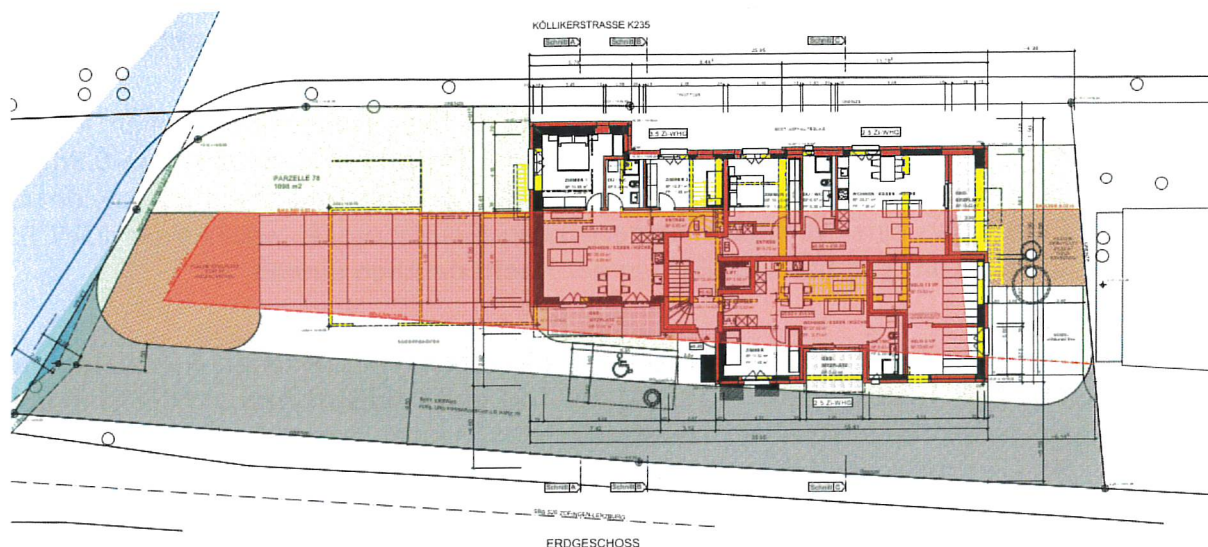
Mögliche Bebauungsfläche bei Neubau (rot)
